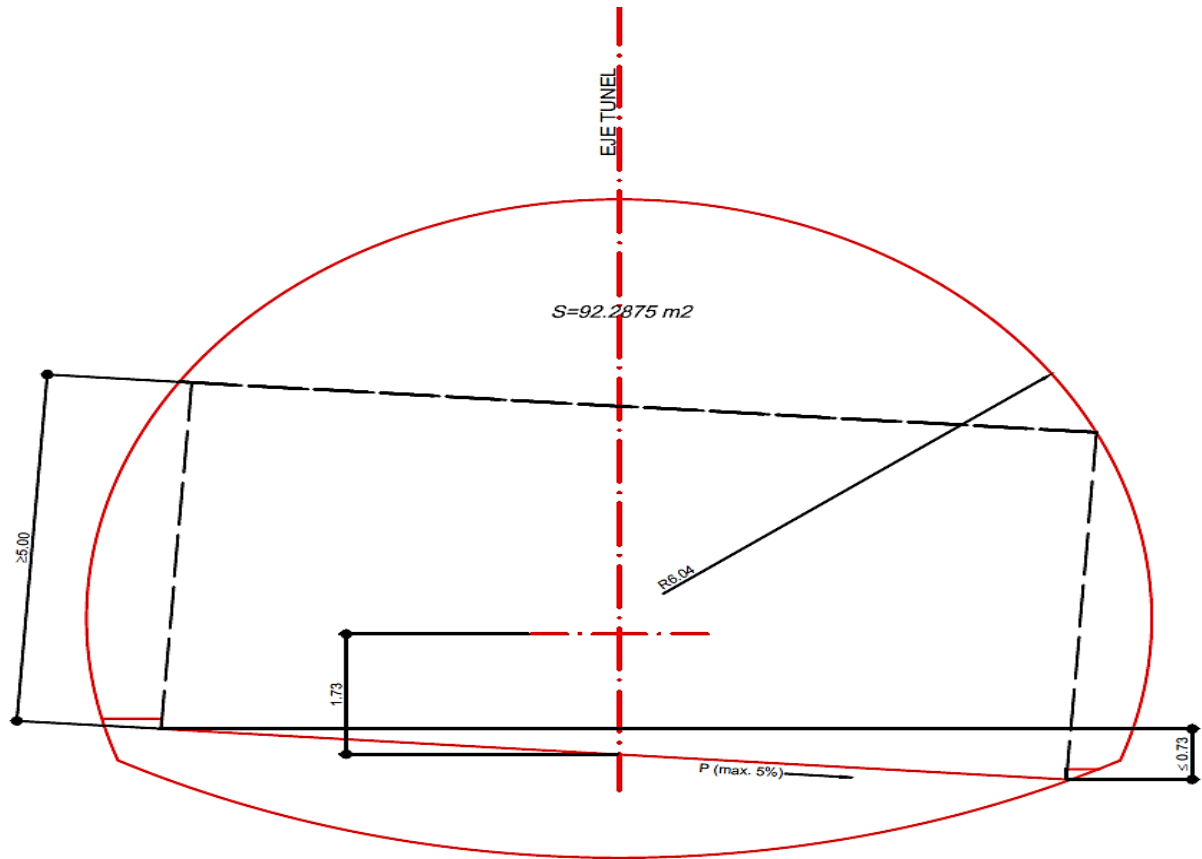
Sección Tipo Reglamentaria. (Elaboración Propia).
